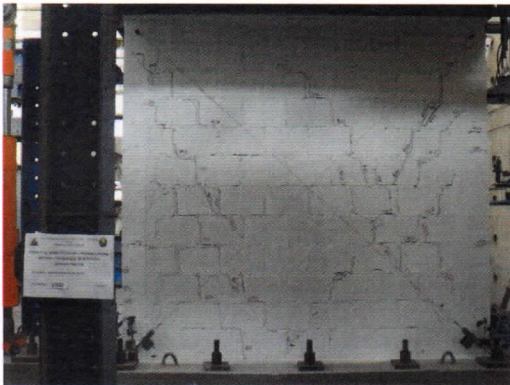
Continuación de grietas en el mortero y el ladrillo en la cara Norte para una distorsión de 1/550.
